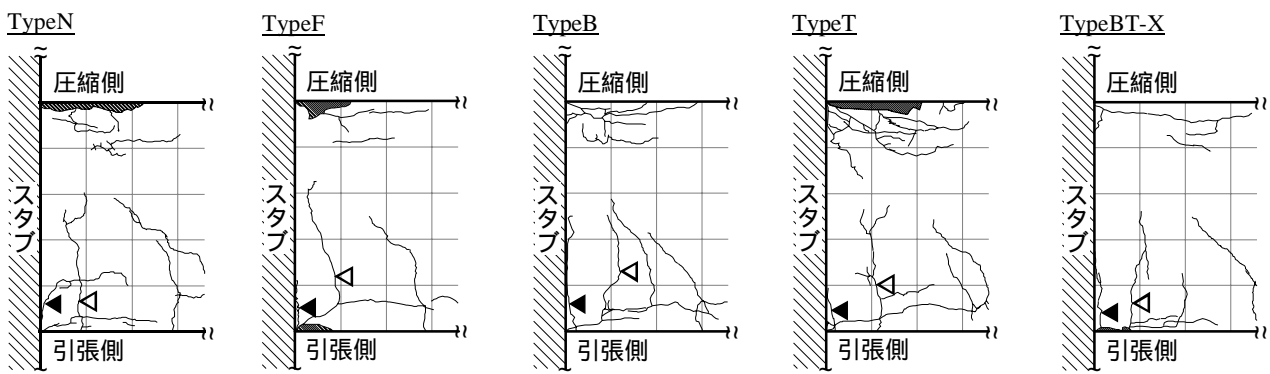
ひび割れ状況図(1/50正方向1回目) ◀: スタブから1本目のひび割れを示す ◁: スタブから2本目のひび割れを示す
